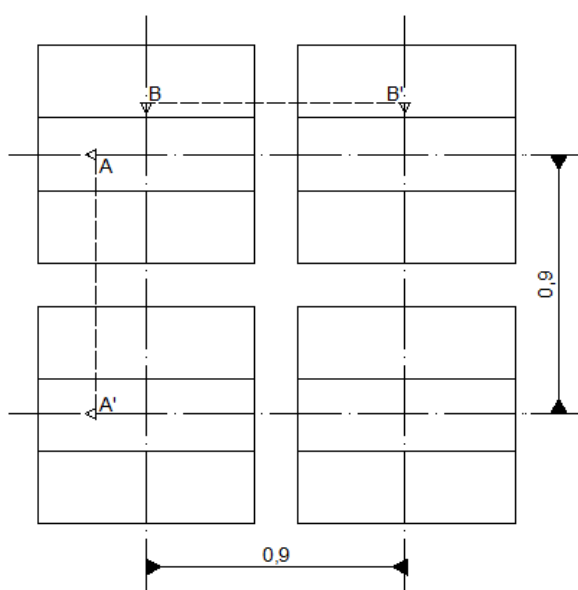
Representação em planta de uma porção de laje composta por quatro zonas de aligeiramento
